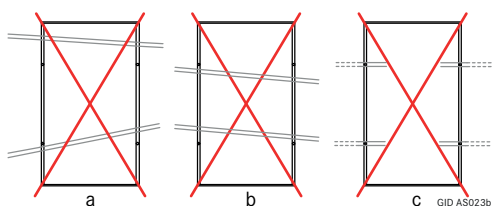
Disposizione non ammessa dei profili di montaggio
